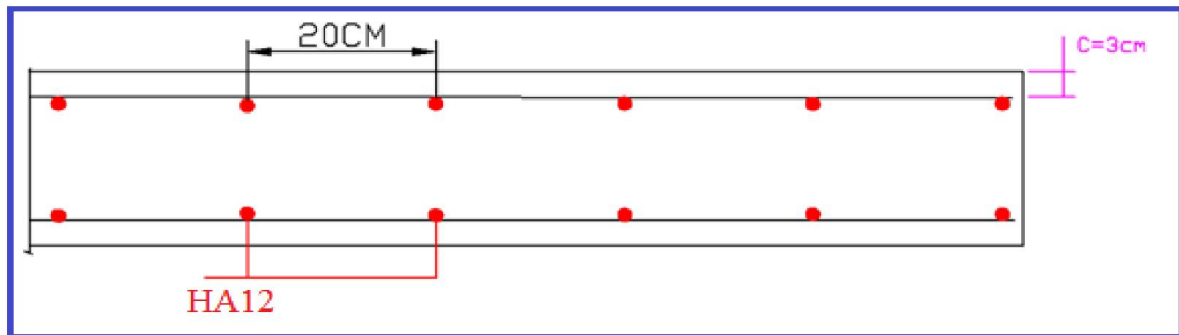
Ferrailage longitudinale de l'hourdis.
